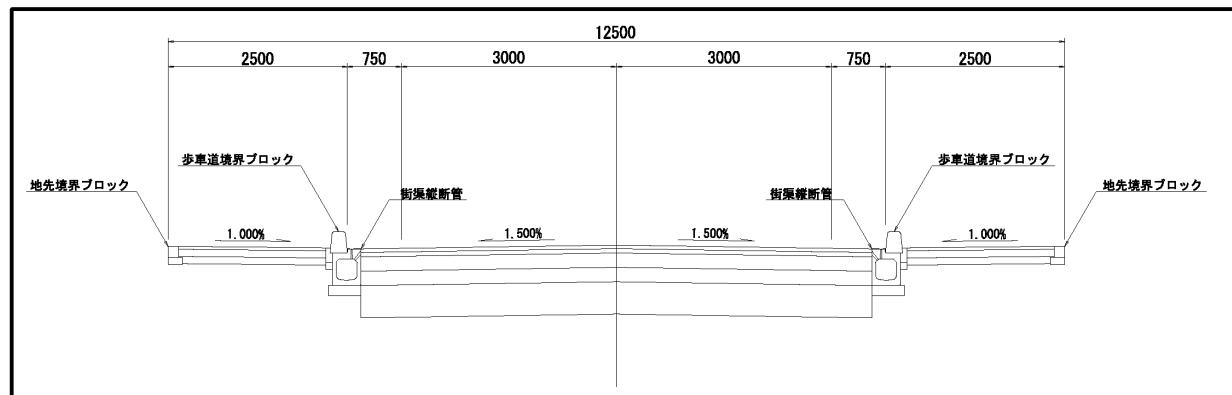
(1) 道路の標準断面図（幹線道路 12.5-1 号線 幅員 12.5m）
